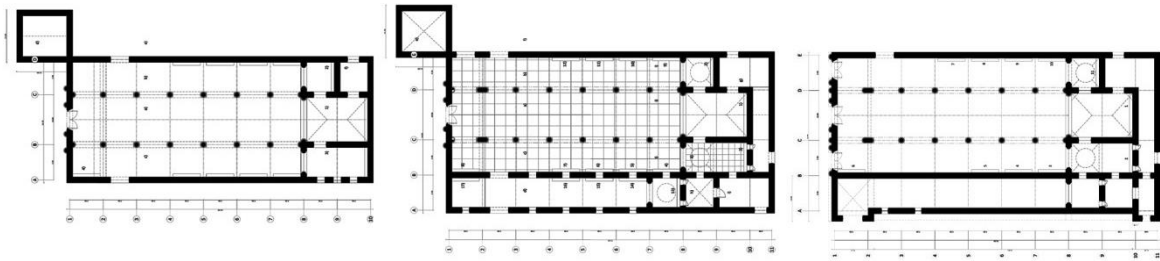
Reconstrucción de las plantas del templo en 1600-1641, 1772 y 1812.
